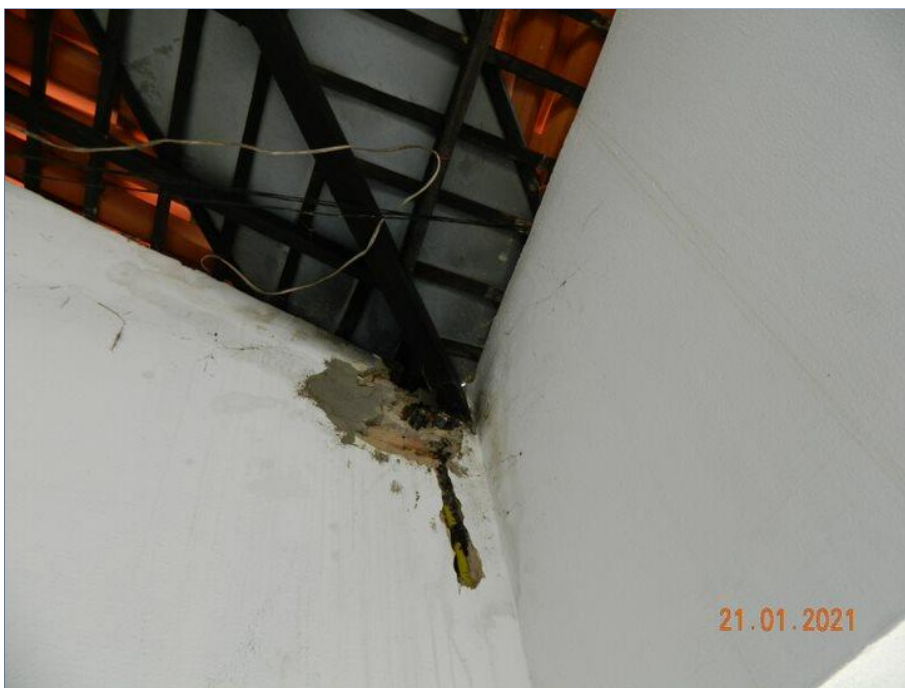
Parede danificada e instalação de lógica irregular.
